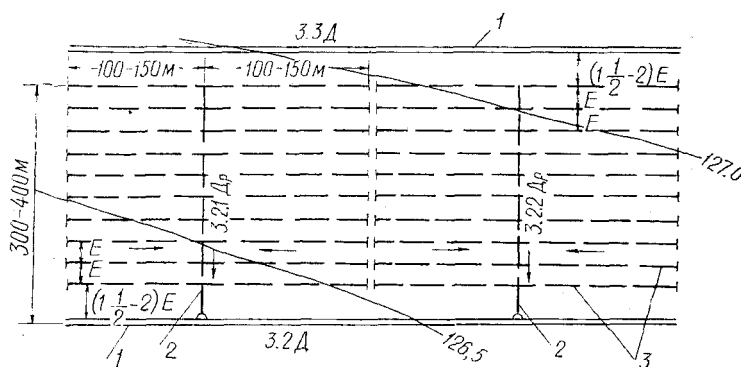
Схемы гончарного дренажа на пойменных землях с незначительными уклонами поверхности земли:
